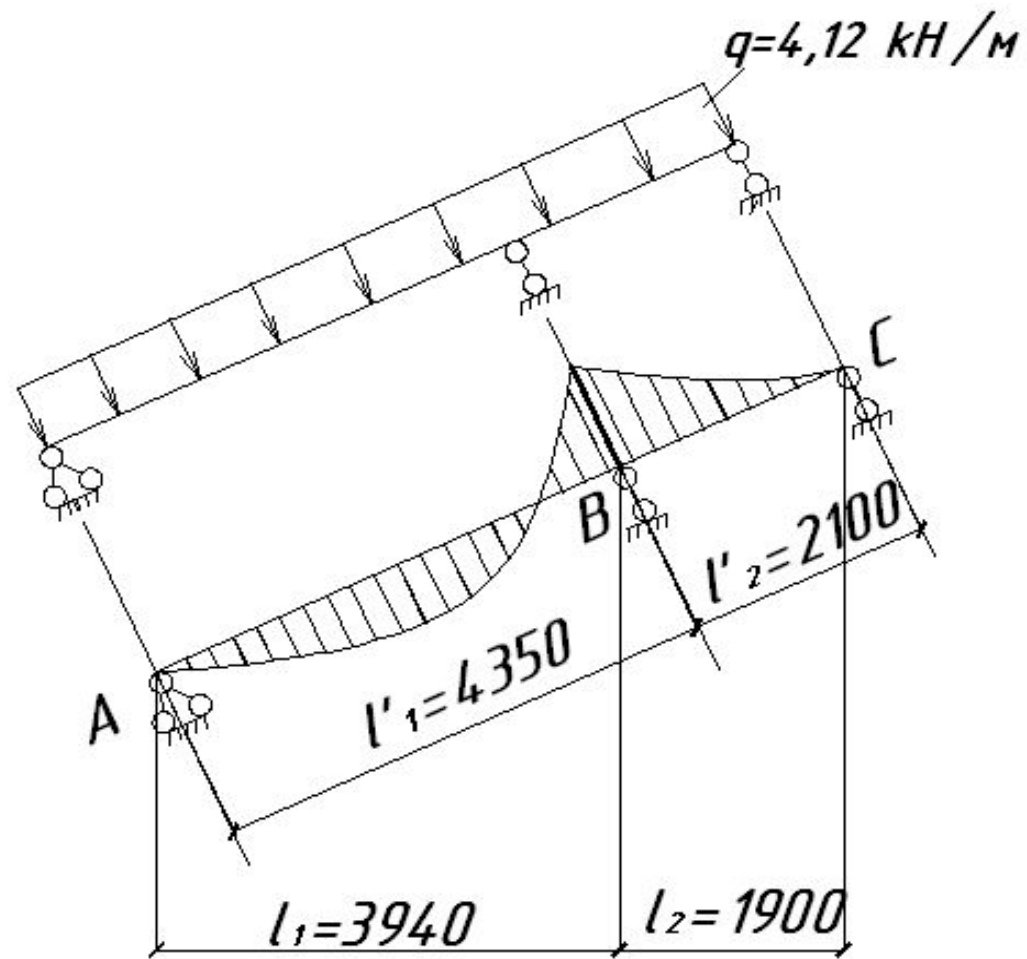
Расчетная схема и эпюра моментов стропильной ноги.
